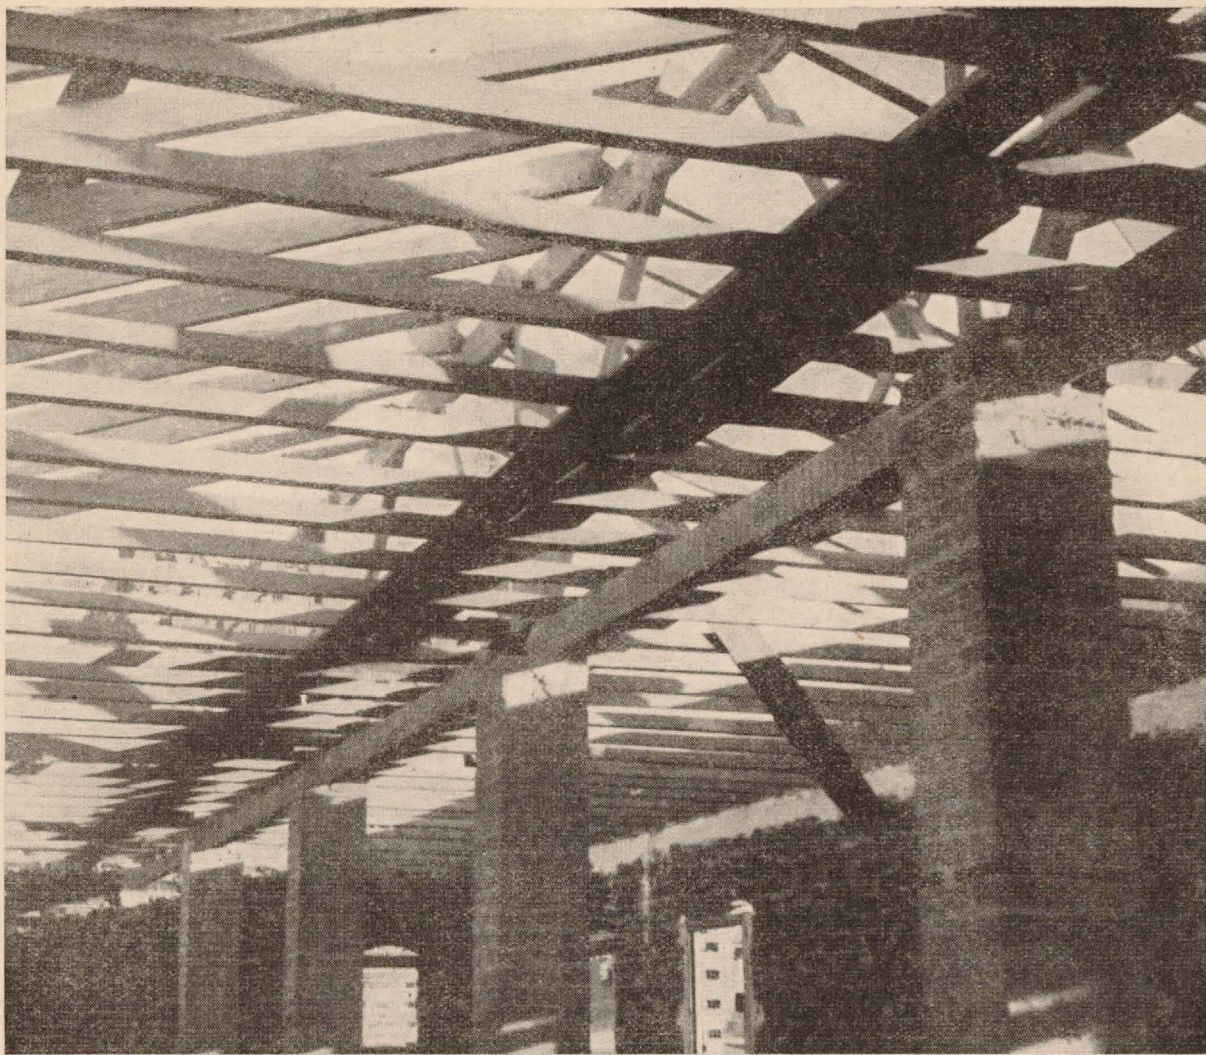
Solución sencilla de cubierta con parecillos a par y picadero.
